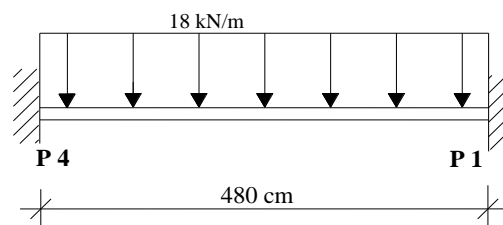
Esquema estático e carregamento no vão da viga adjacente ao pilar P1.
